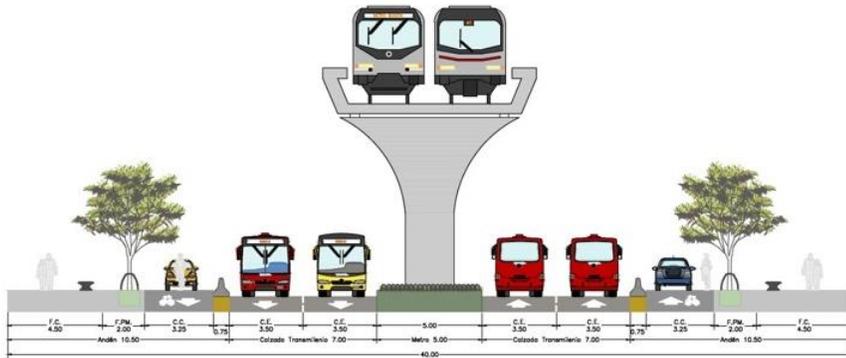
Sección transversal a nivel entre estaciones en la Avenida Caracas entre la Calle 26 y la Calle 76
